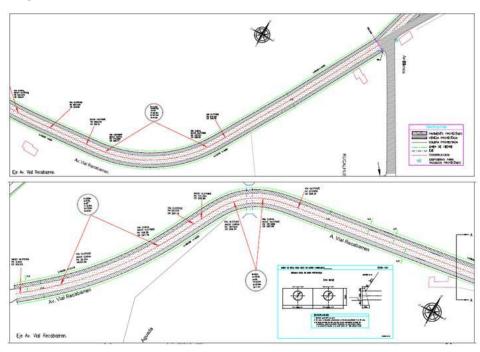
Diseño Conexión Vial Recabarren a Villa San Rafael
